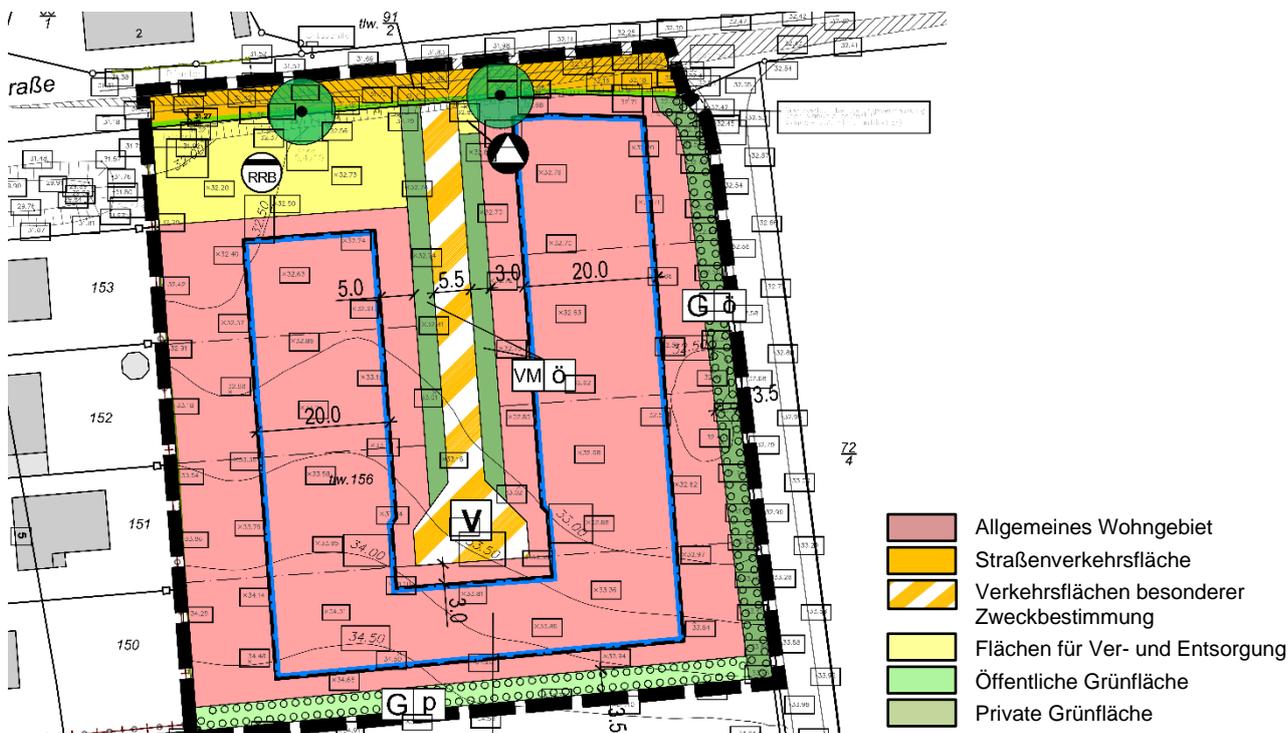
Ausschnitt aus B-Plan Nr. 2 – Planzeichnung (s. [U4])
